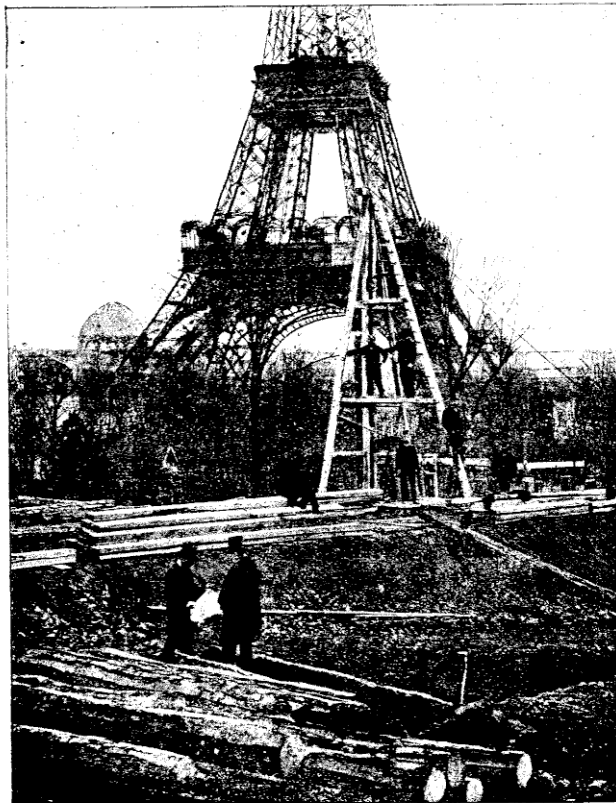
Premiers travaux. — Plantation des pilotis.
